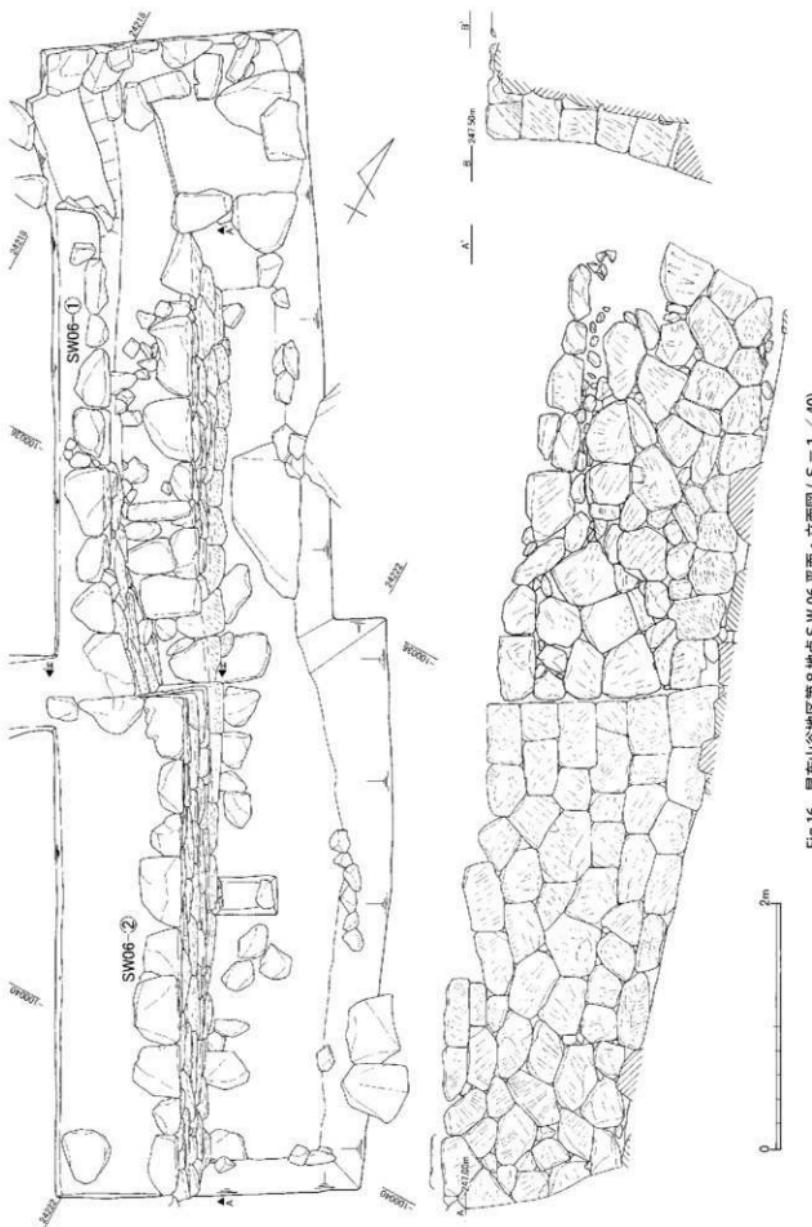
昆布山谷地区第8地点 SW 06 平面・立面図 ($S = 1 / 40$)
